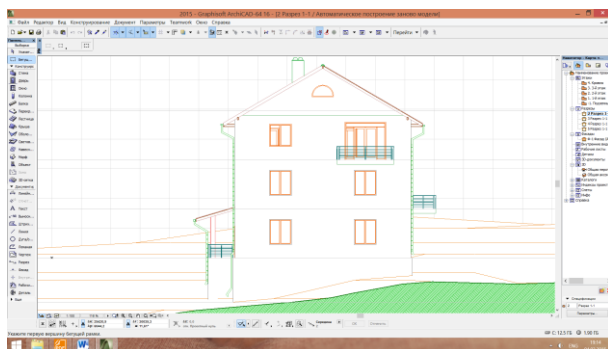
Приклади виконання креслень фасадів будинку котеджного типу на схилі в системі ArchiCAD.
